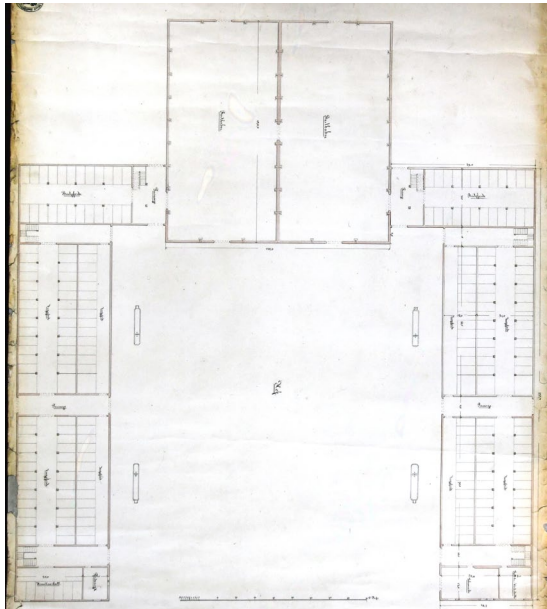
Grundriss der Anlage mit Doppelreitbahn und Stallungen (Quelle: StATG 2569).
